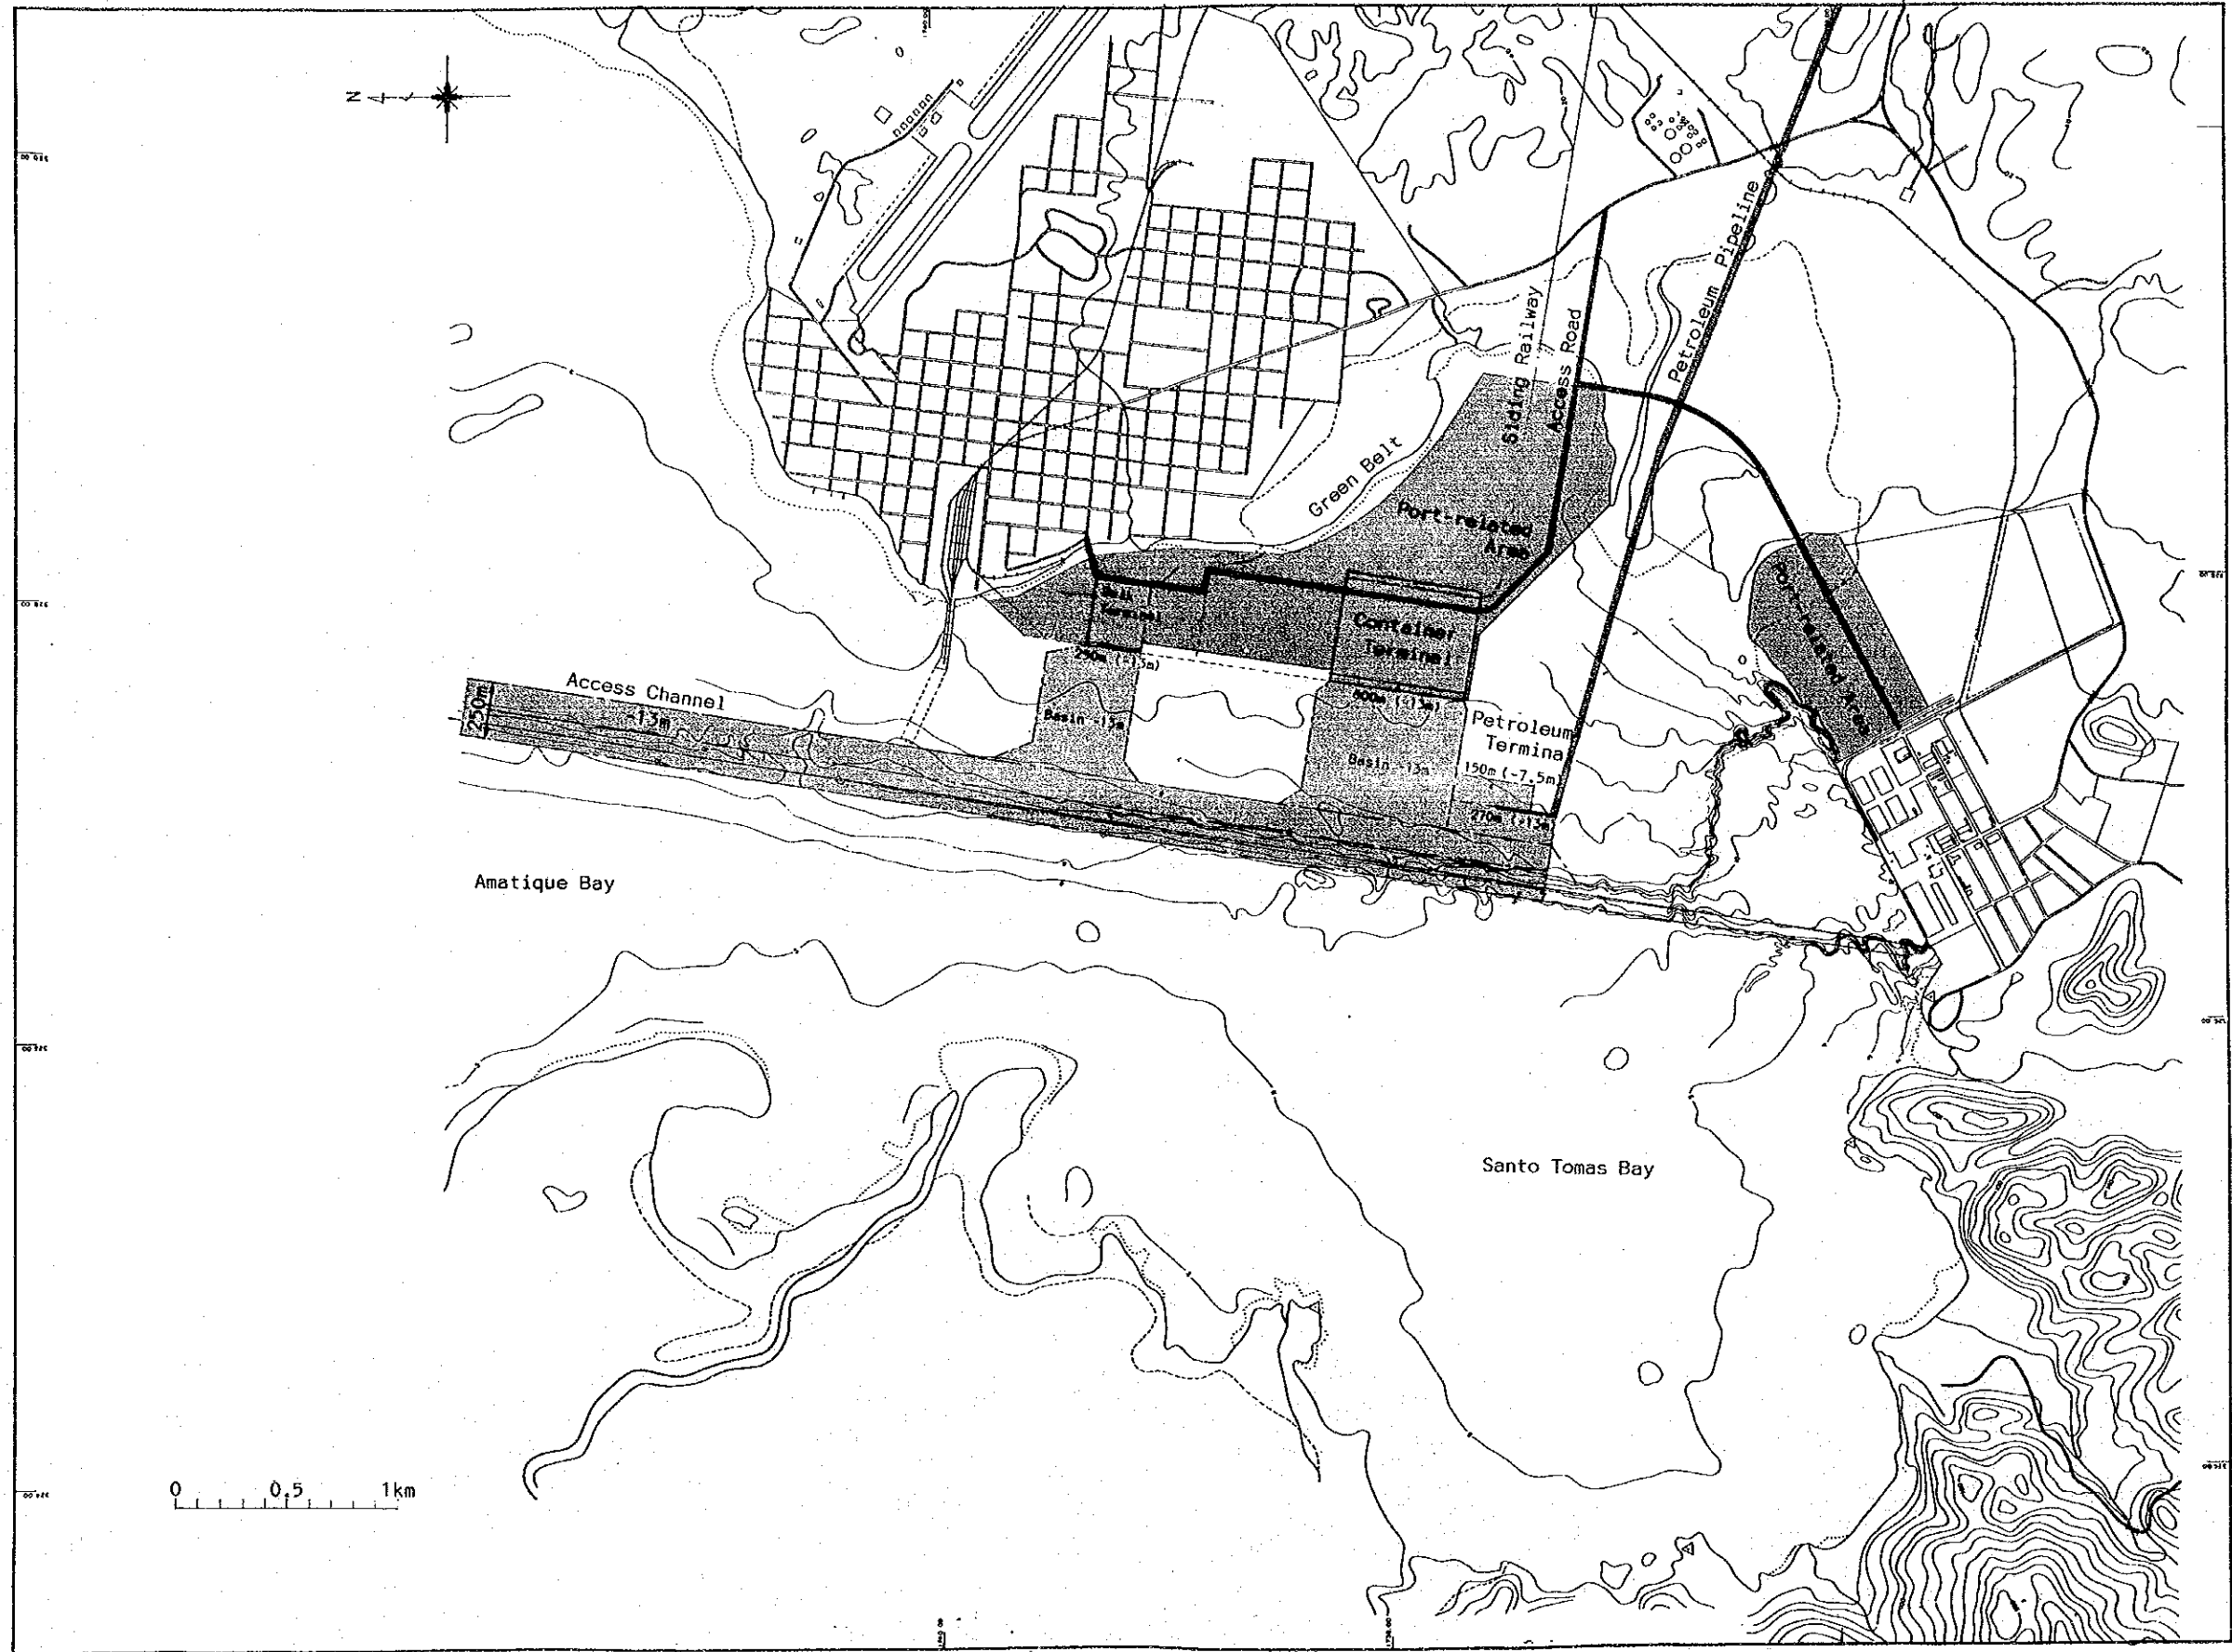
Plan Alternativo de Distribución---Caso 3
